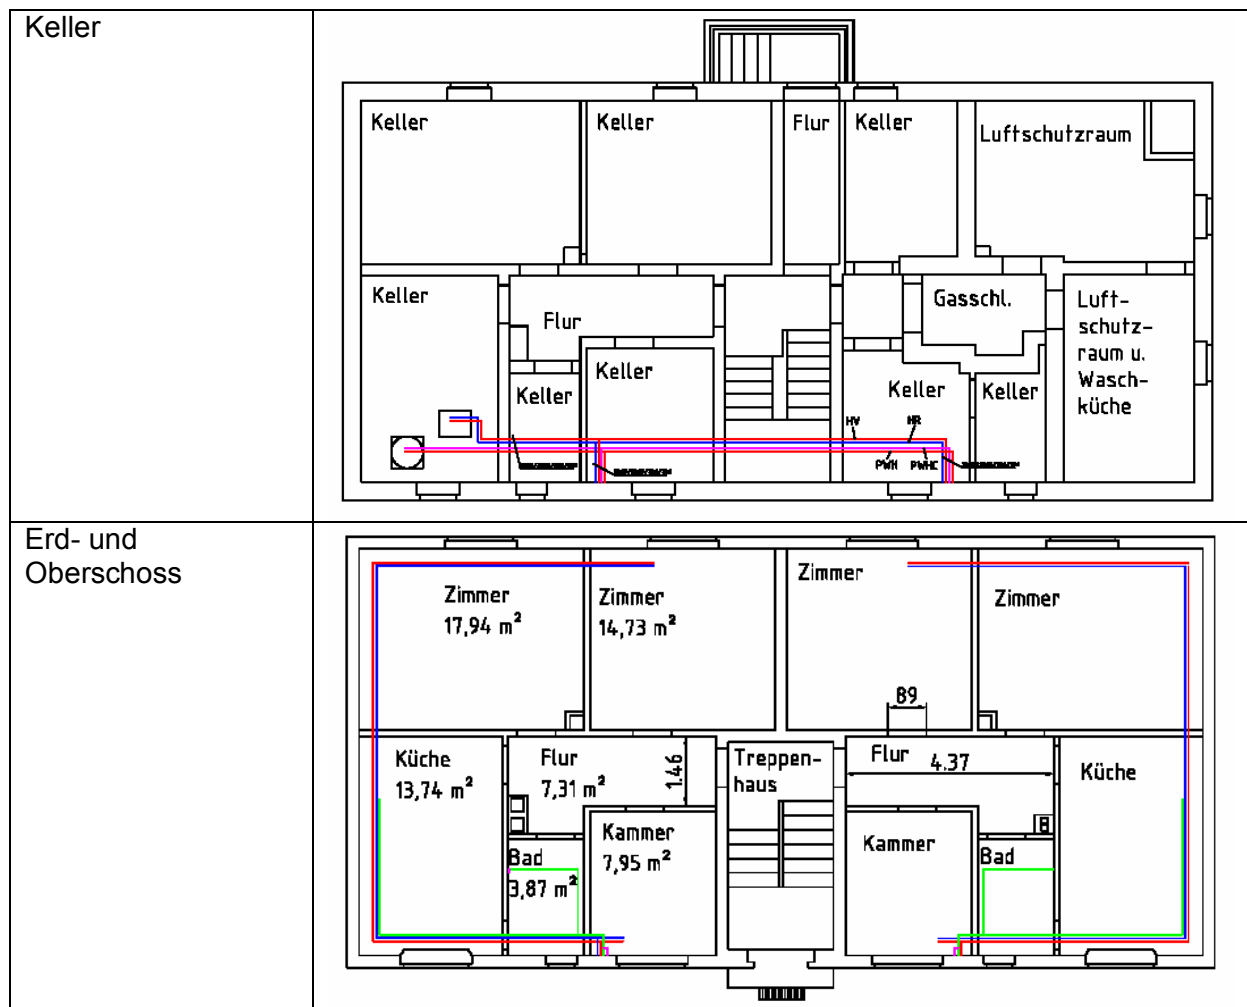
Grundrisse der Geschosse mit Leitungswegen – Mettlacher Straße
